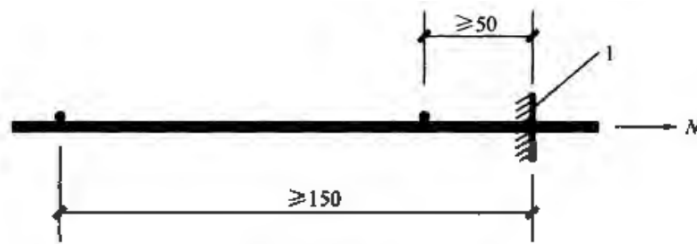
受拉光面钢筋焊接网的锚固
